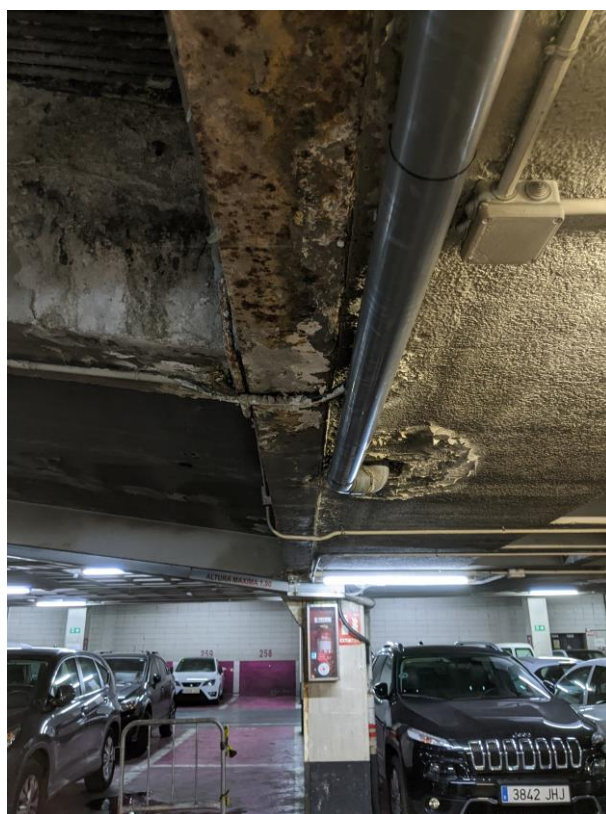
Viga dintel metálica rampa de acceso al aparcamiento
